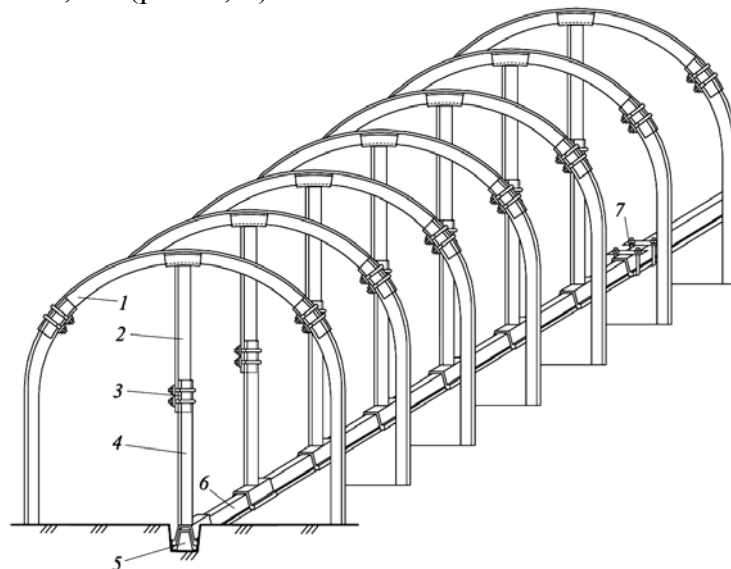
Схема установки стоек крепи усиления на продольный металлический лежень по почве пласта: 1 – крепь выработки; 2 – верхняя часть стойки крепи усиления; 3 – замковое соединение стойки крепи усиления; 4 – нижняя часть стойки крепи усиления; 5 – канавка под продольный лежень; 6 – продольный лежень; 7 – замковое соединение отрезков лежня
